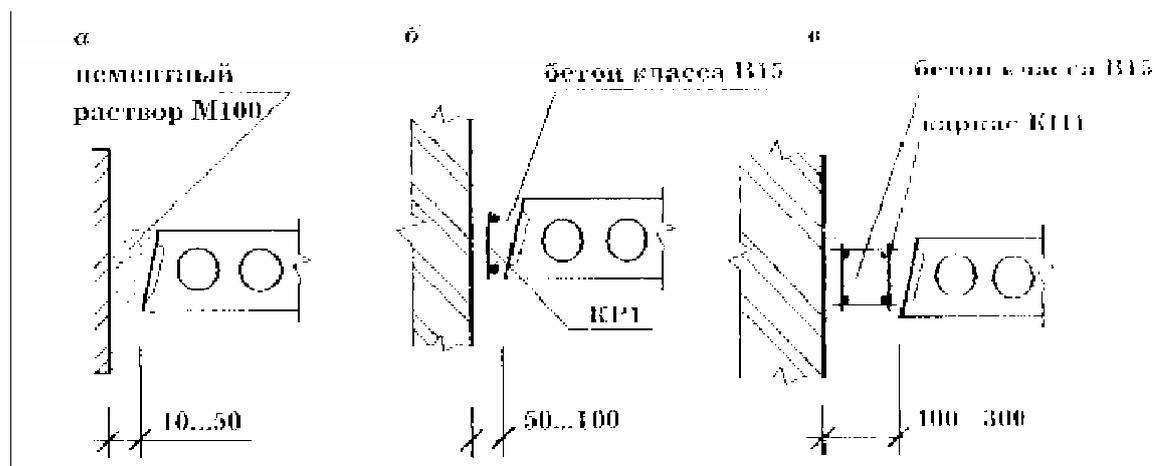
Примыкание плит к самонесущим стенам и монолитные участки
